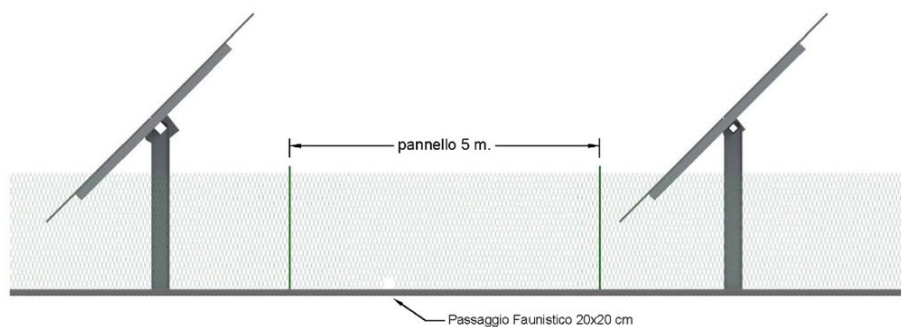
Prospetto recinzione perimetrale senza mitigazione
